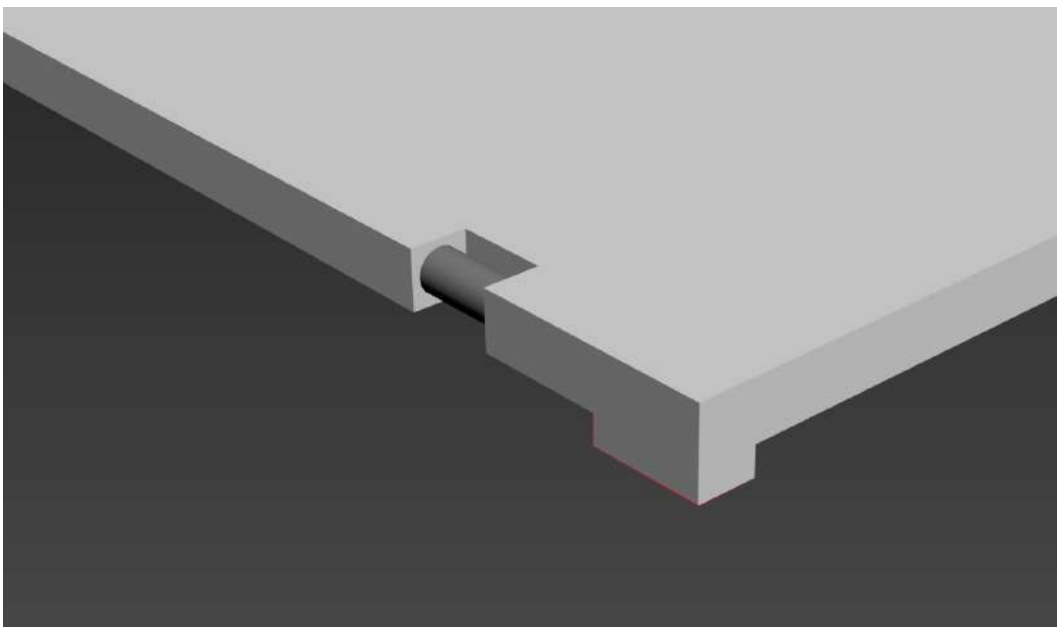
Render detalle abisagrado container “Fuente: Elaboración propia”
